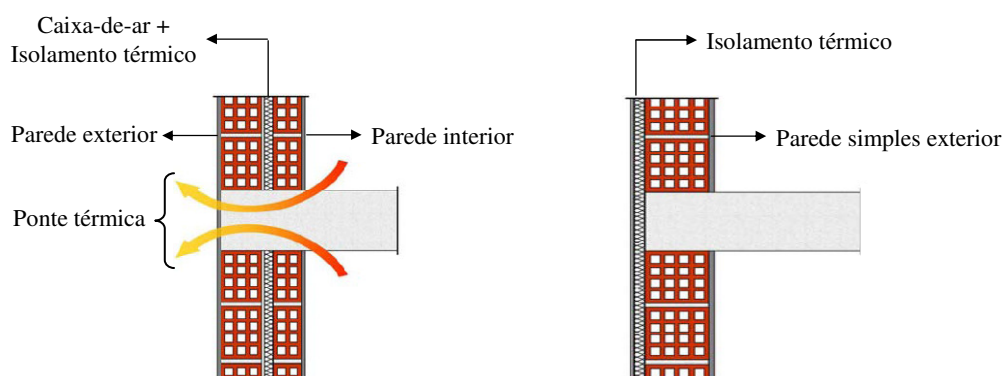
Isolamento térmico aplicado na caixa-de-ar em paredes duplas (imagem do lado esquerdo) e aplicado pelo exterior em paredes simples (imagem do lado direito) (Fonte: Peixoto de Freitas, 2002)
